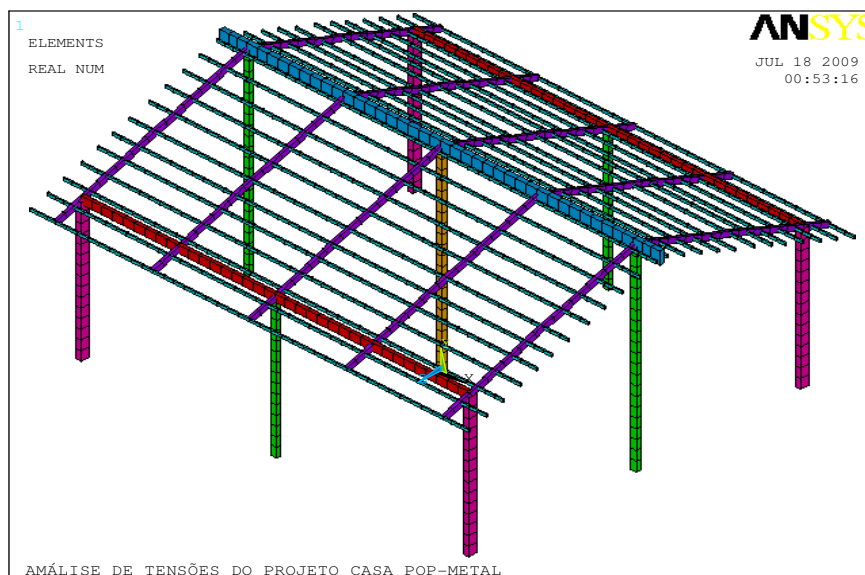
Perfis da estrutura metálica. Projeto USITETO.
